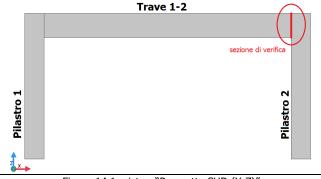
vista - "Prospetto SUD (X-Z)"
